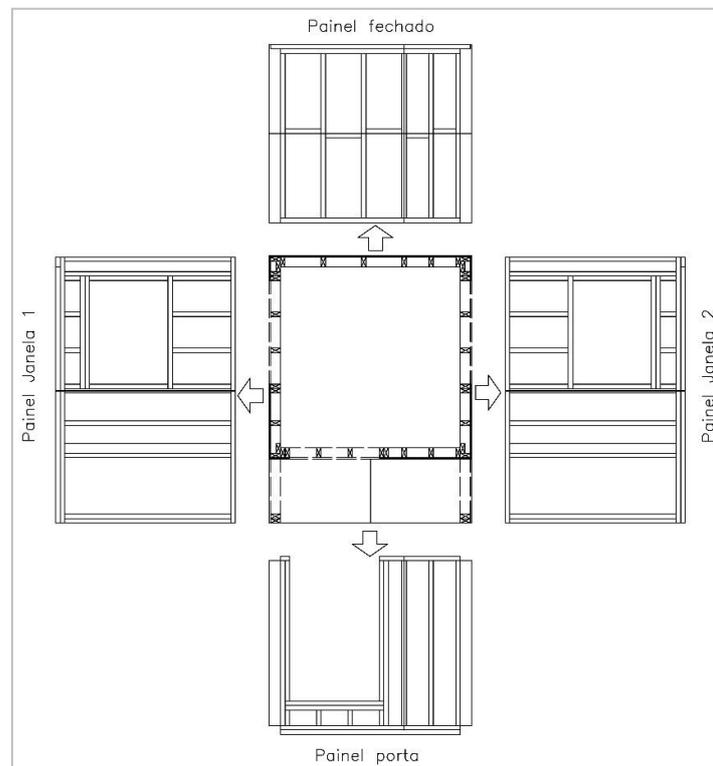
Posição dos painéis de piso e de parede para montagem no canteiro. Fonte: Autores.
